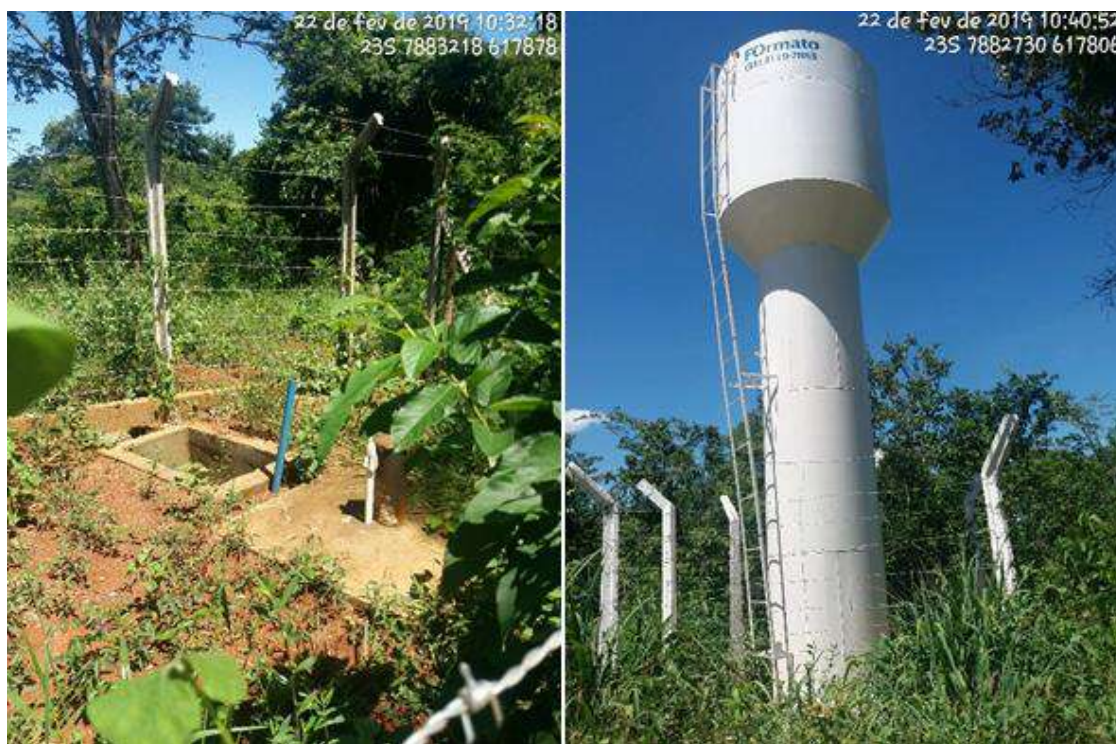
Instalações do poço artesiano e reservatório do Sistema Baú
